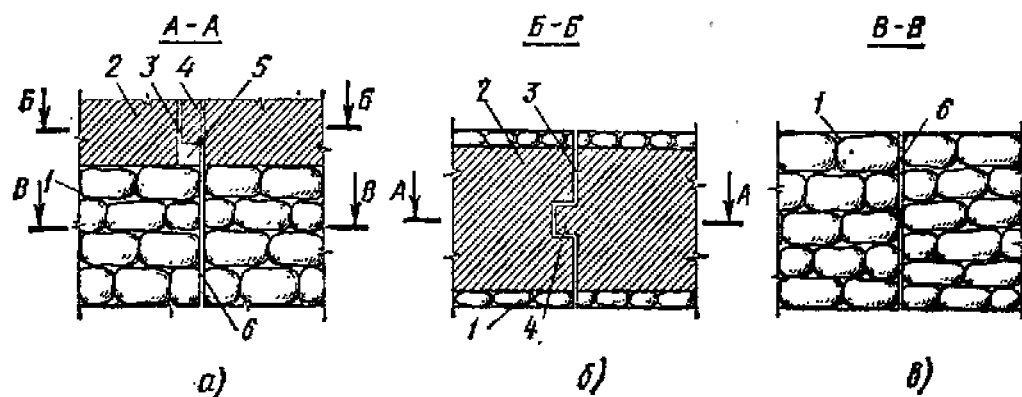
Переход от осадочного шва фундамента к осадочному шву стены: а — разрез, б — план стены, в — план фундамента; 1 — фундамент, 2 — стена, 3 — шов стены, 4 — шпунт, 5 — зазор для осадки, 6 — шов фундамента
